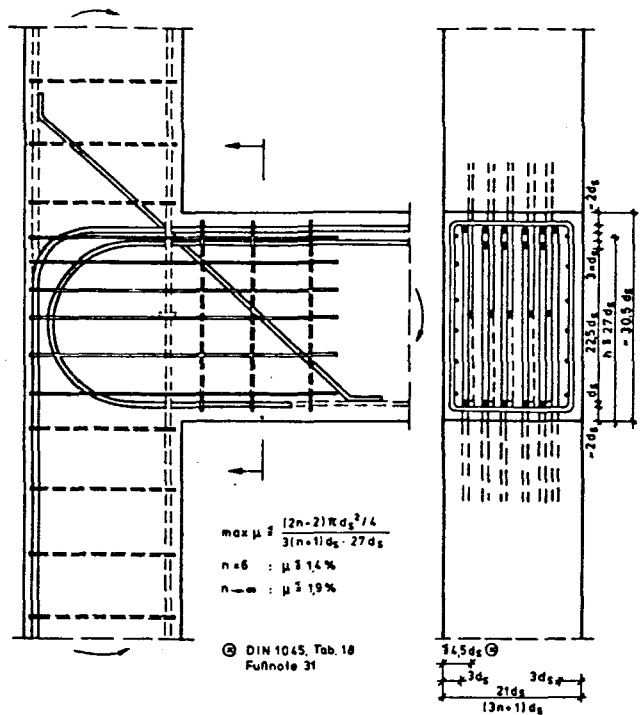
Rahmenendknoten mit zweilagiger Bewehrung des Riegels
